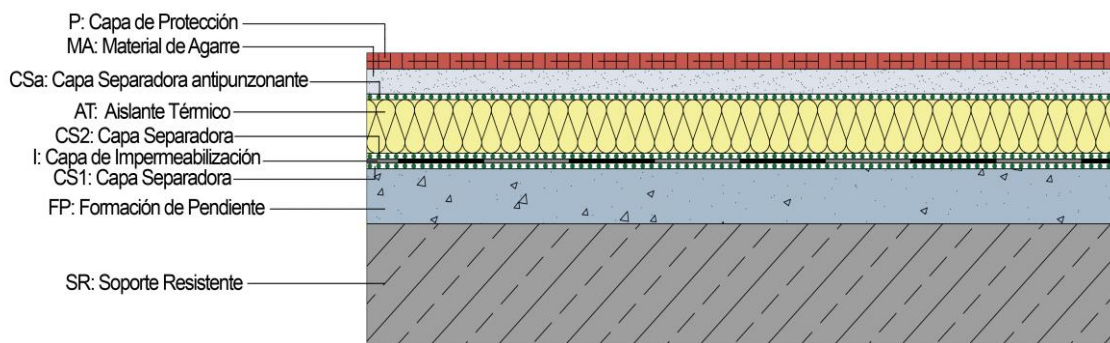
Representación de la cubierta plana invertida sin cámara de aire II.
